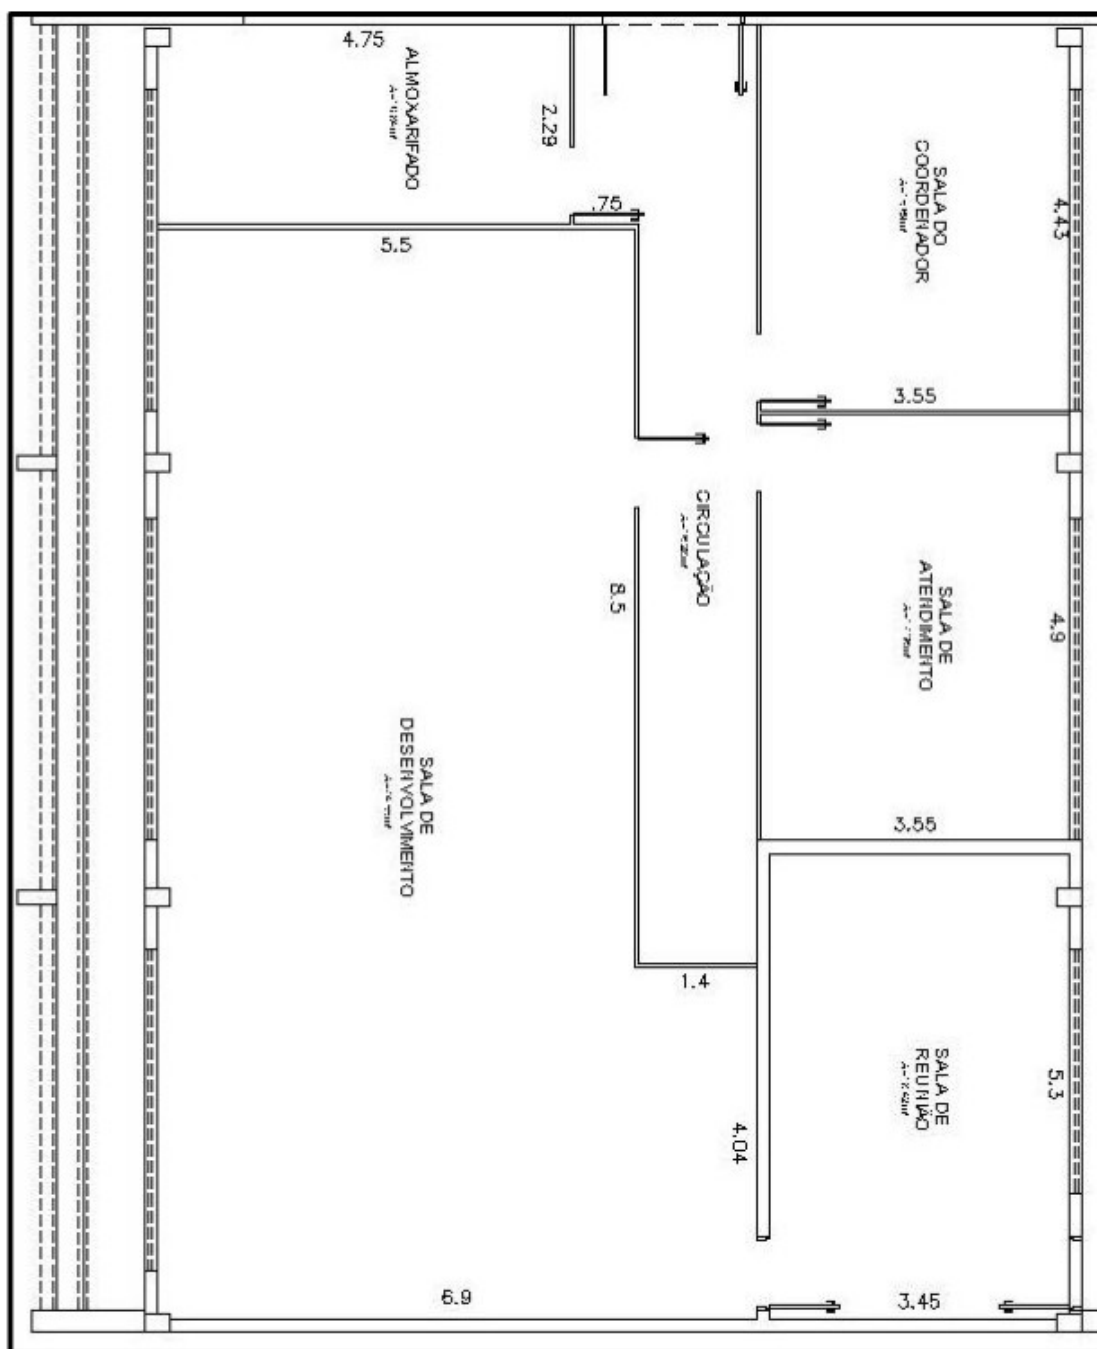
Planta baixa – COIN (DITS e Hall de entrada)
